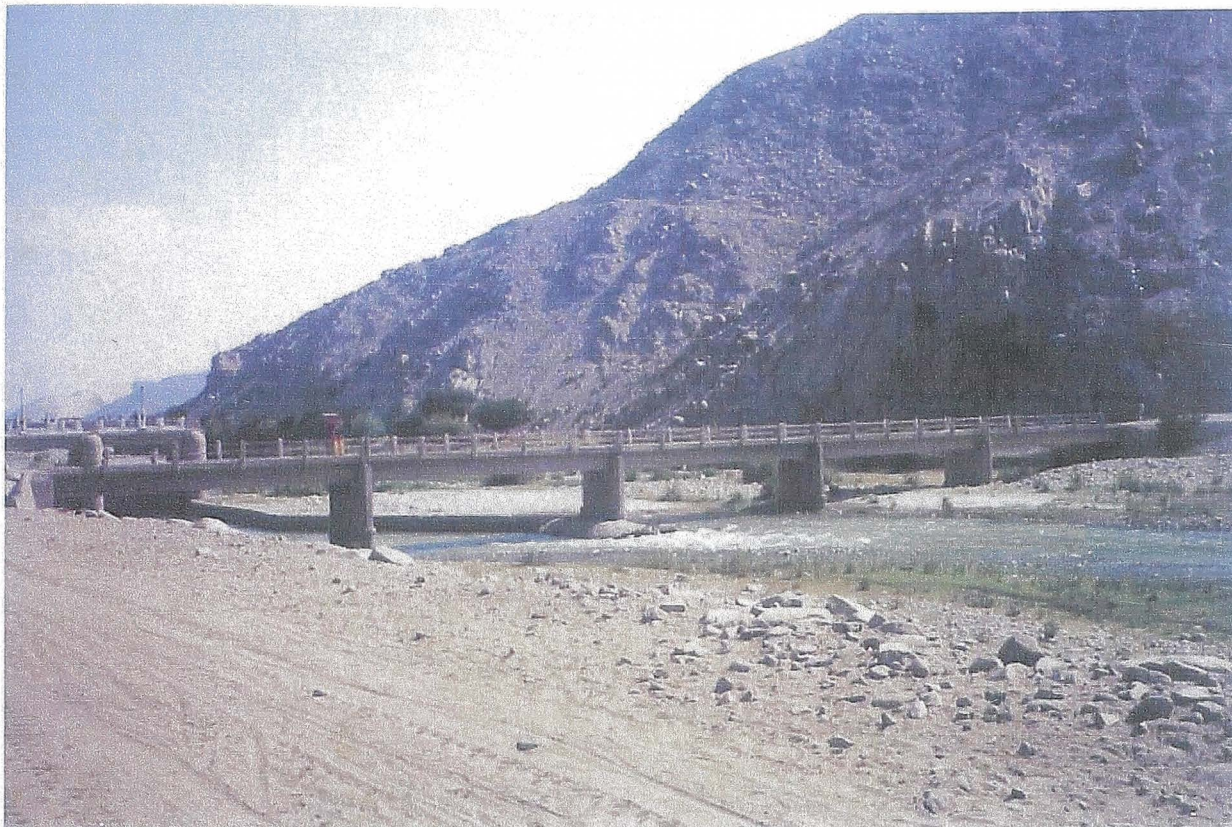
EN LA FOTO SE OBSERVA EL PUENTE HUAMANI SOBRE EL RIO ICA, SE PUEDE VER QUE EL SEGUNDO PILAR HA SIDO REFORZADO CON UNA BASE DE CONCRETO.
